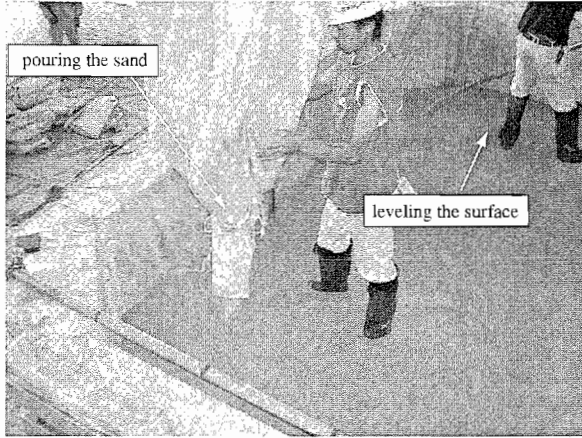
地盤材料 (豊浦標準砂) 投入状況
